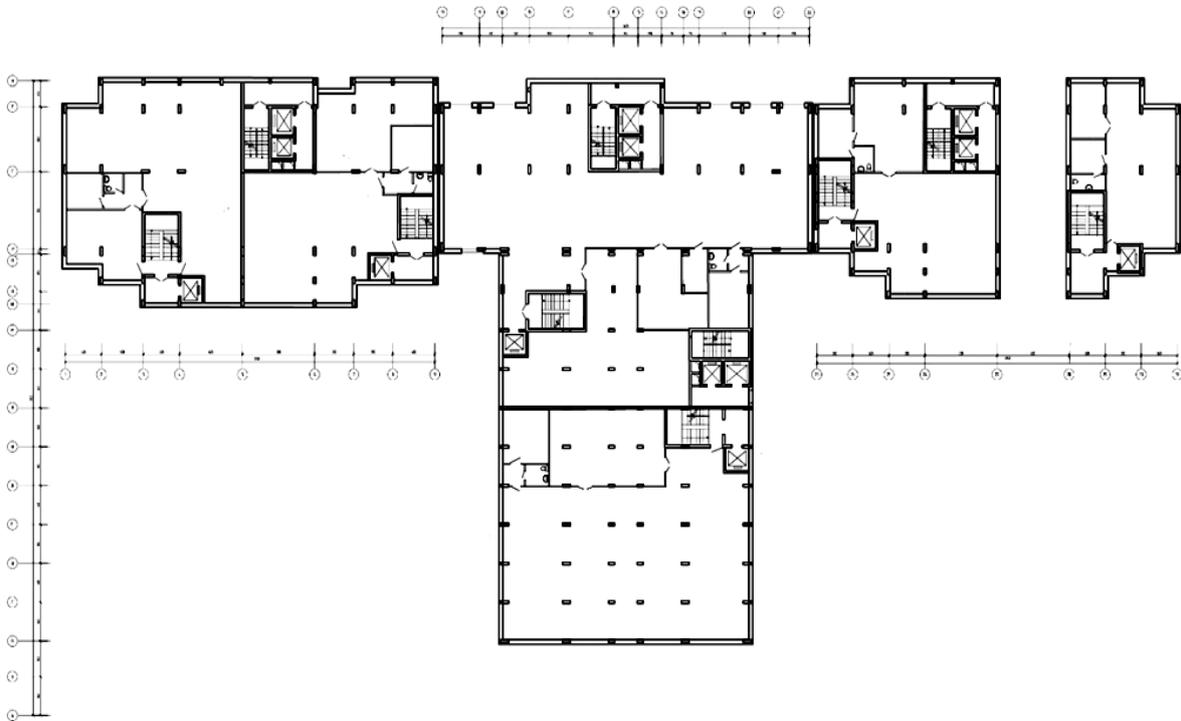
План 2 этажа на +4.20 м с помещениями общественного назначения
